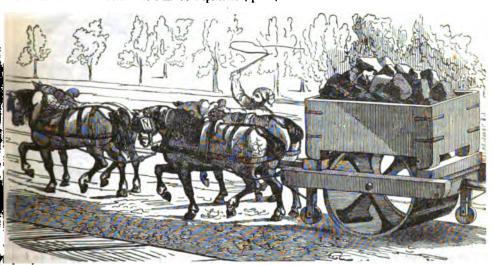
Rouleau compresseur pour chaussées d'empierrement.
